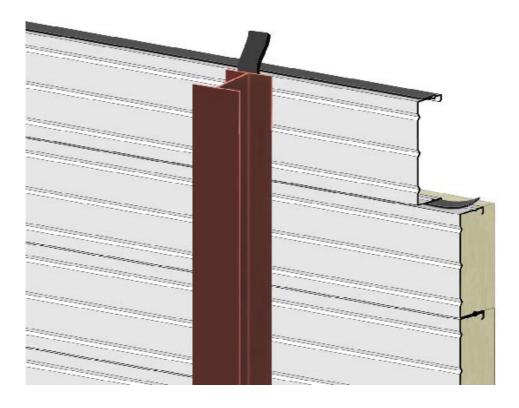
is – Mise en place du joint d'étanchéité SUPER ETANCOPLAST sur plateaux métalliques pleins
